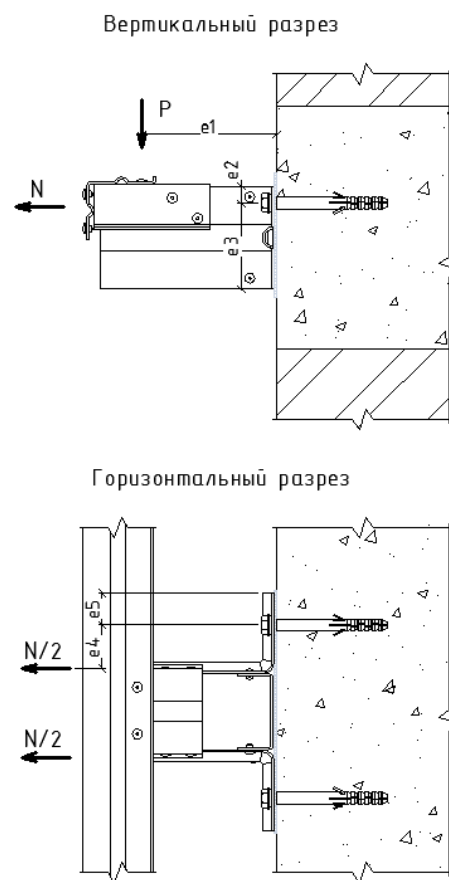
Расчётная схема кронштейна КНс-27 для проверки анкерного элемента на вырыв
